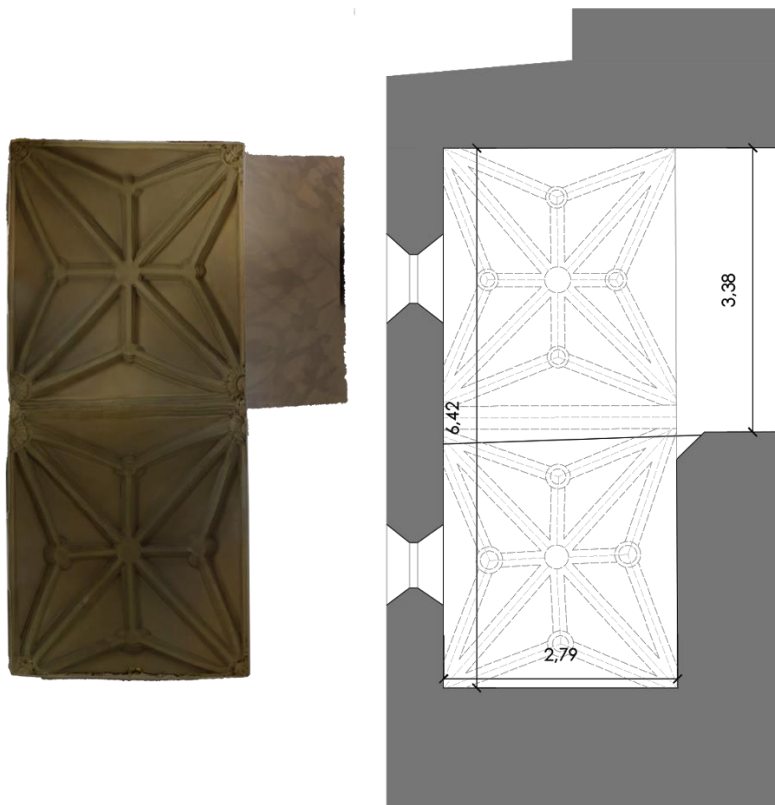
Planta de la Capilla Capitan Monte Bernardo
